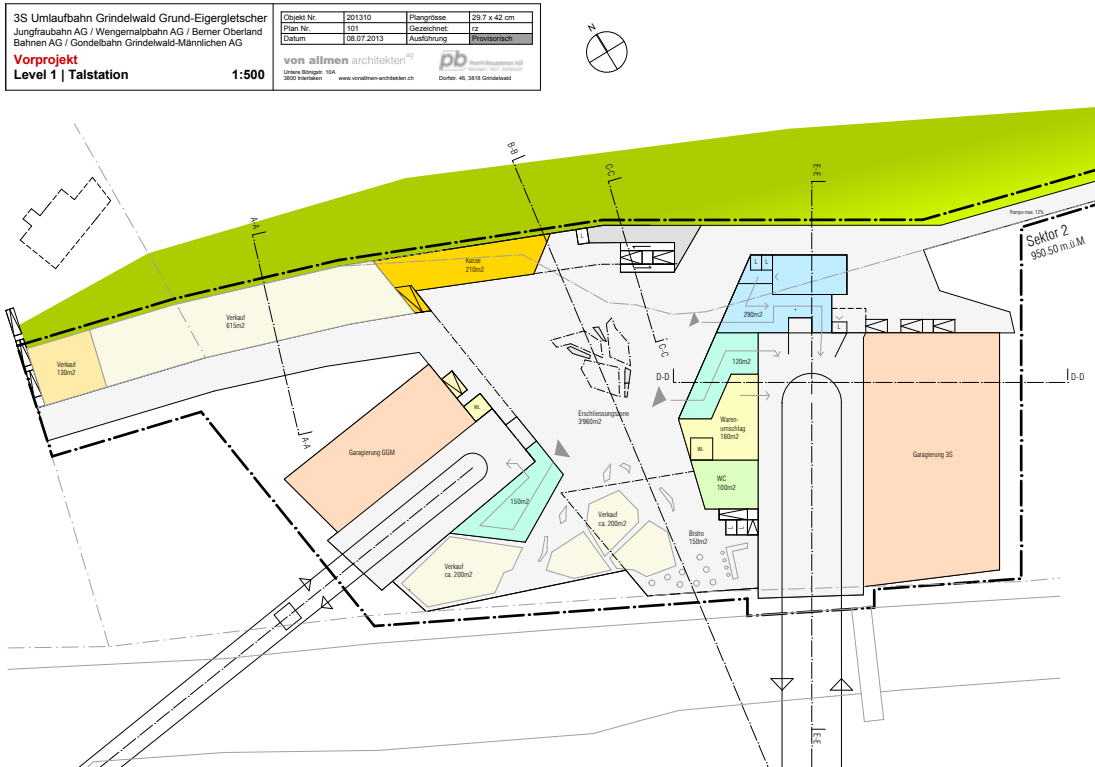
Talstation Grund, Situation Obergeschoss mit Parkhaus
